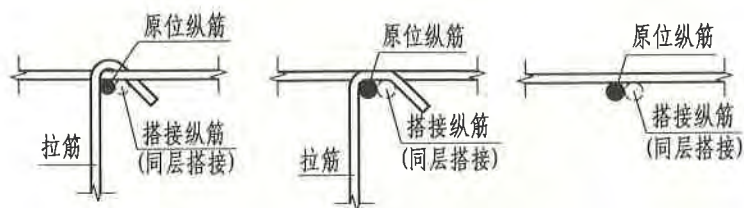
剪力墙分布钢筋处的钢筋搭接位置
